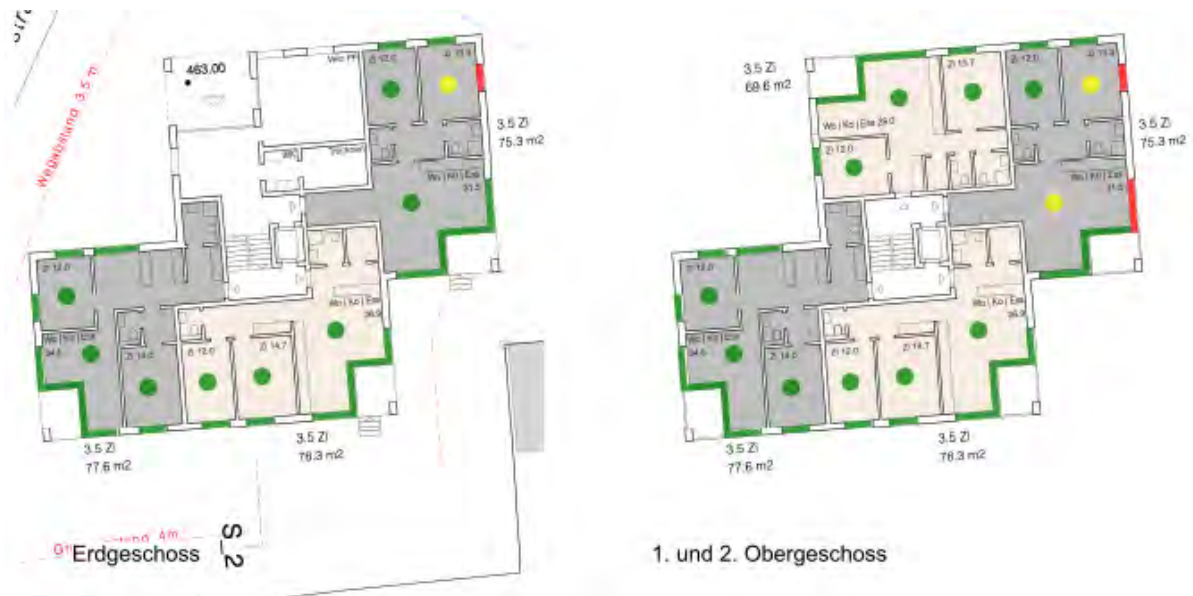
Grundrisse Baufeld S2 mit Lärmbeurteilung
